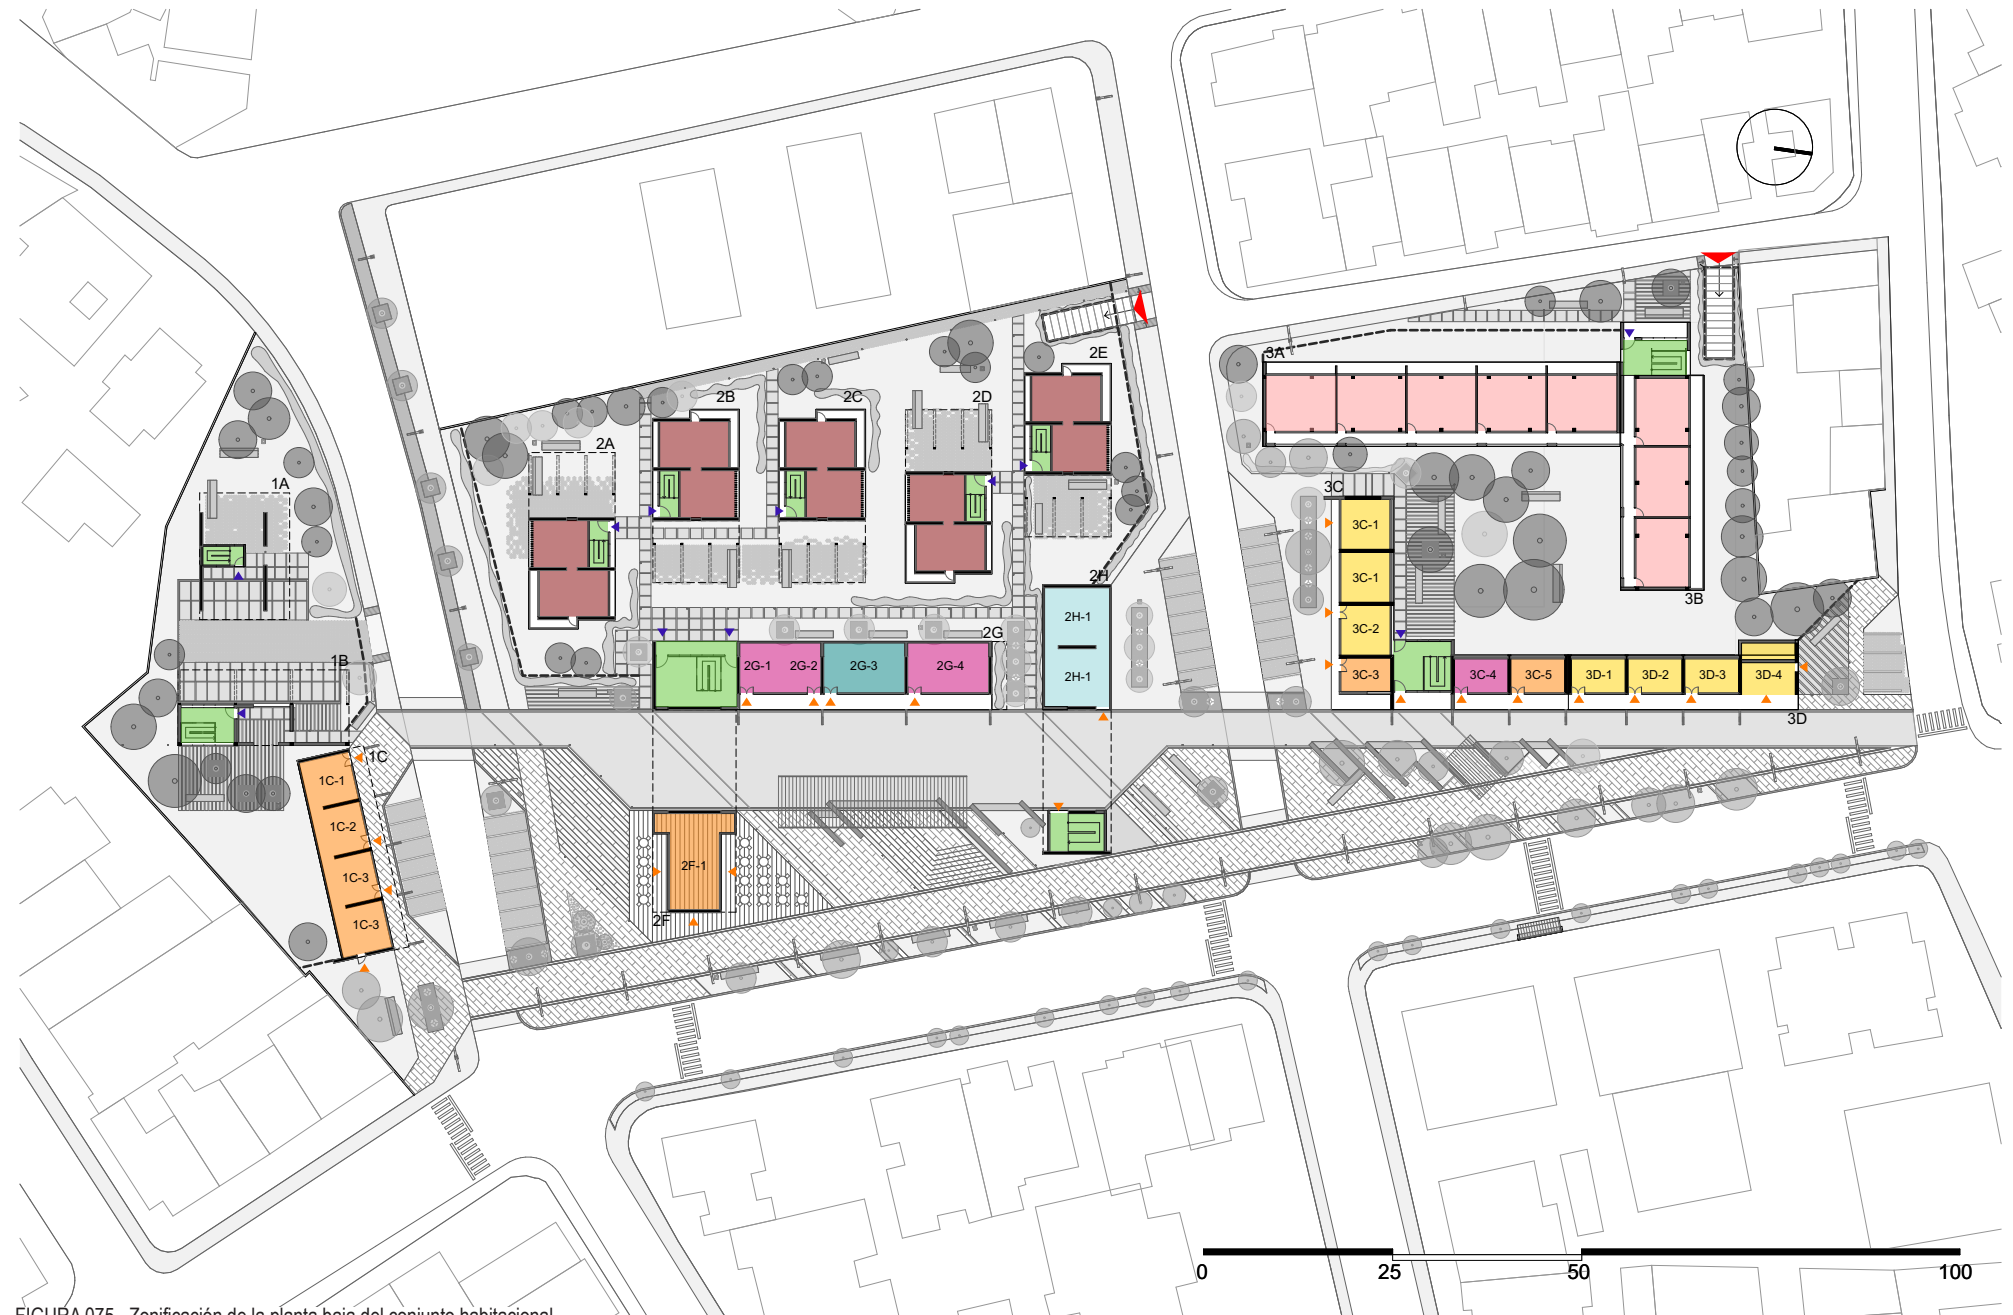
\_ Zonificación de la planta baja del conjunto habitacional
